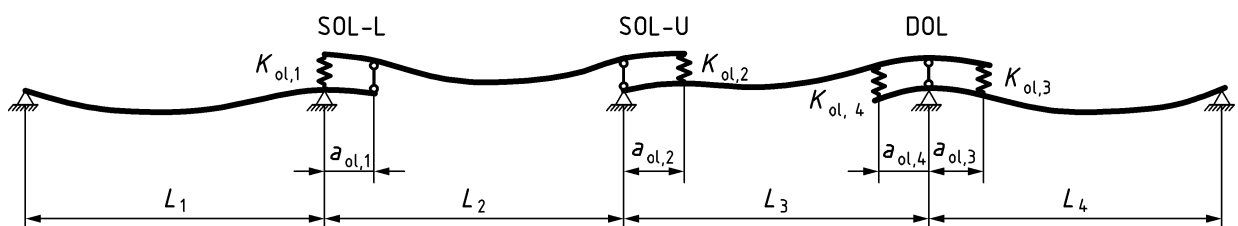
Statisches System für Trapezprofile mit einzelner Überdeckung an den Auflagern
